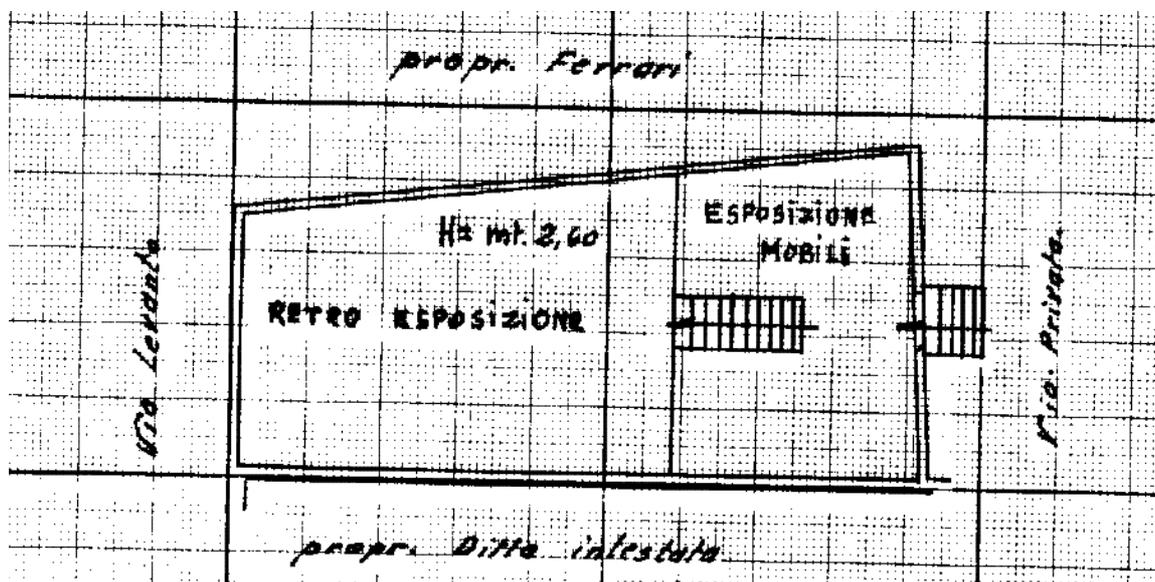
STRALCIO PLANIMETRICO DELL'U.I.U. OGGETTO DI ANALISI (FONTE: INTERNA).
